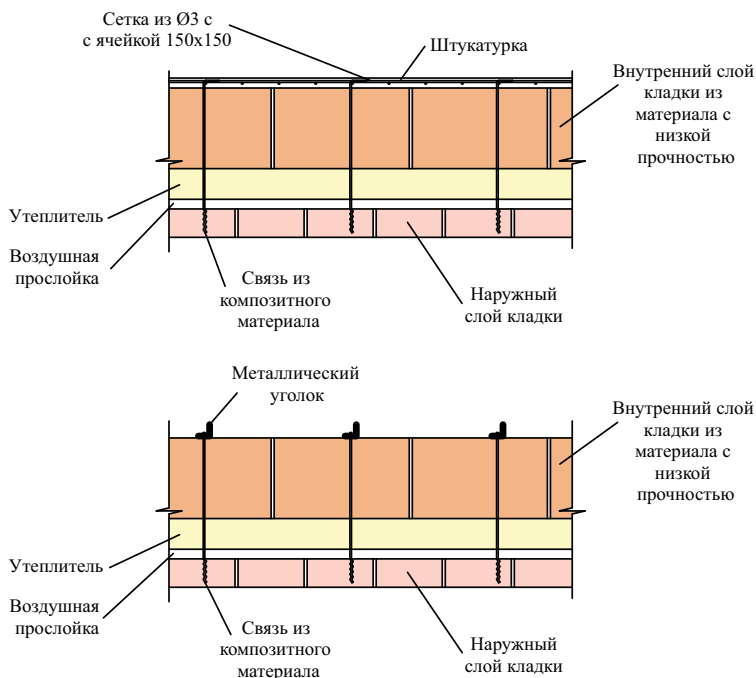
Схема анкерки связей при внутреннем слое кладки из материалов с низкой прочностью
